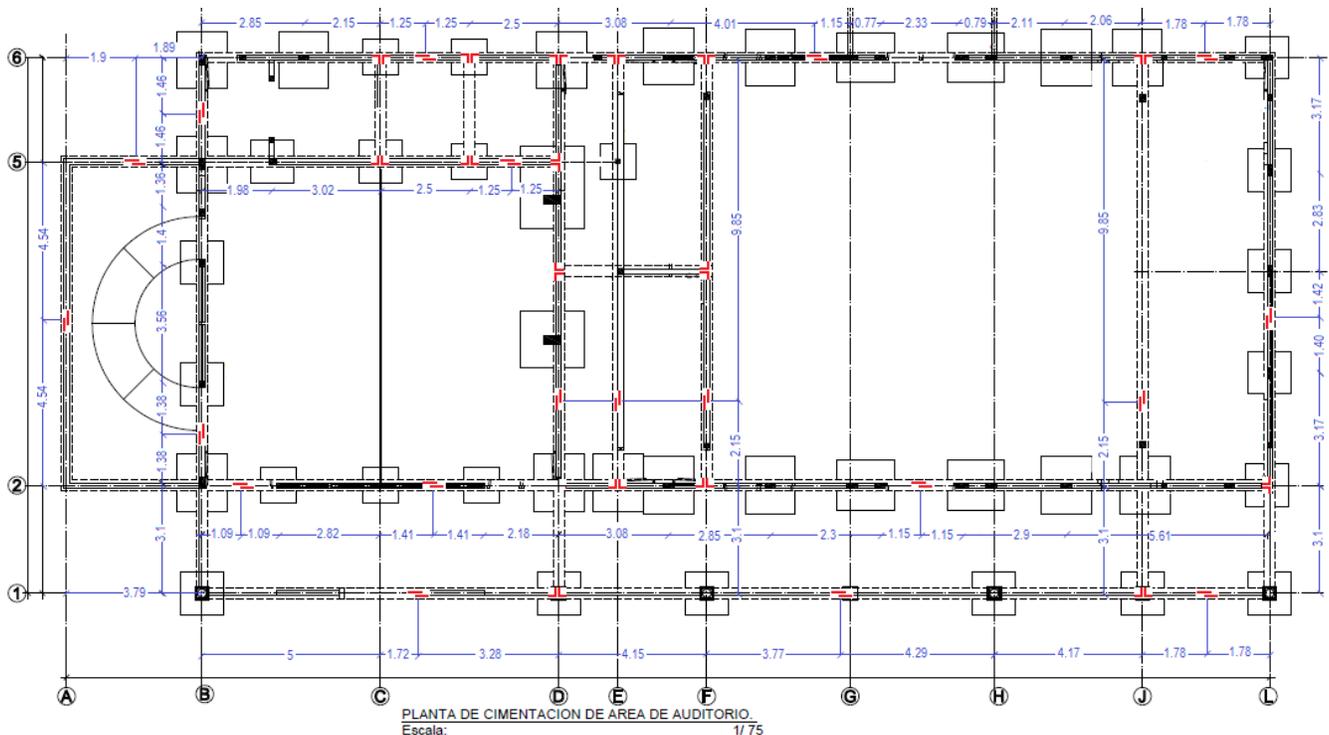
Perímetro de Viga y ubicación de traslape y anclajes, según planos.
